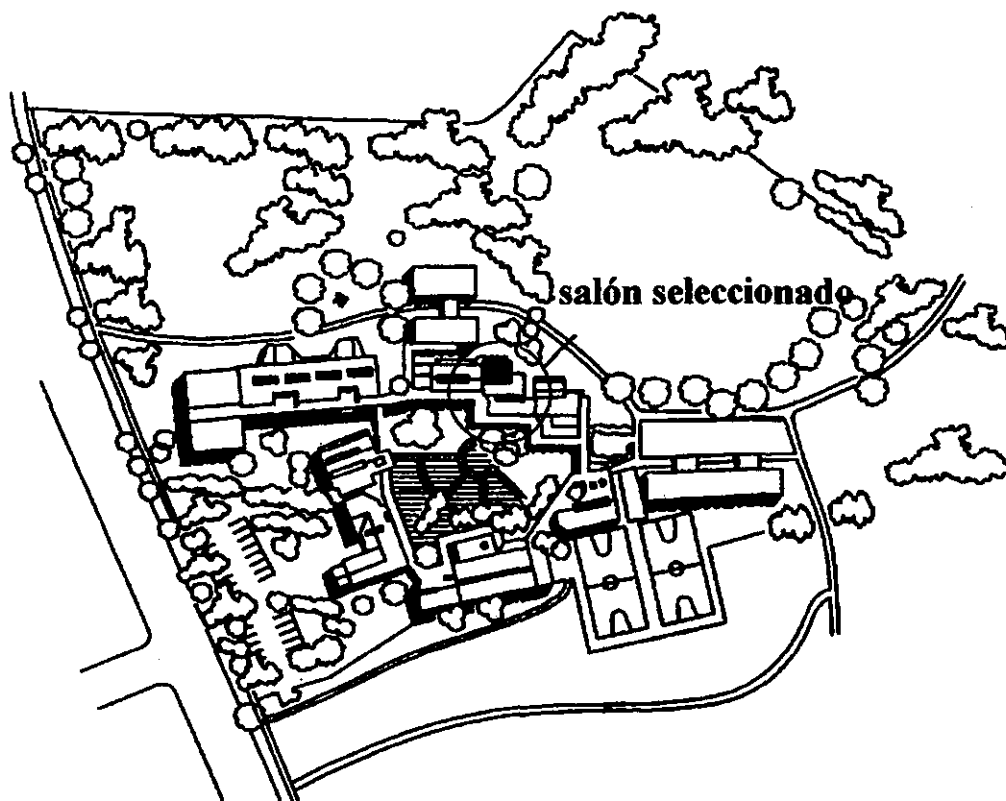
Plano de Conjunto de la escuela Primaria Park Ridge Park
